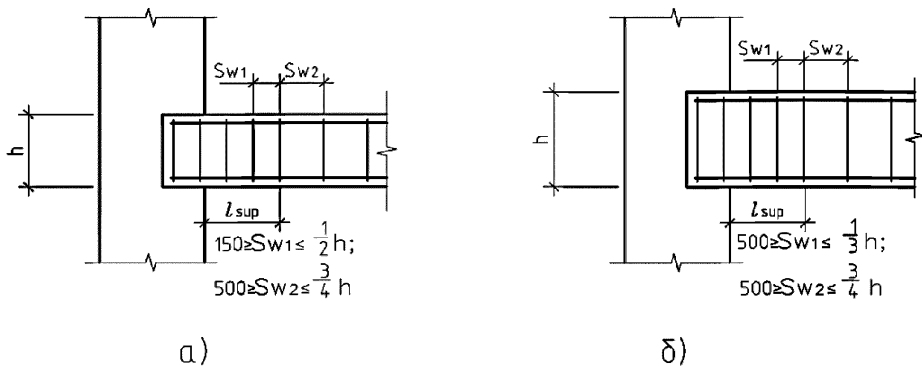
Расположение поперечной арматуры в балках без отгибов:
